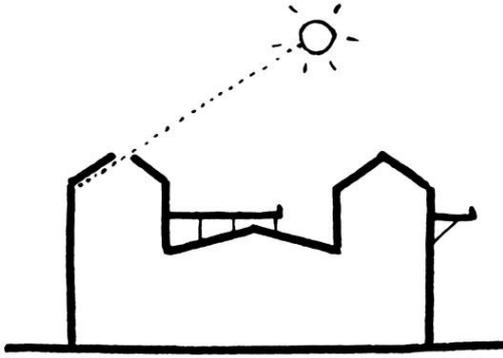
Sección esquemática de la adaptación de otras arquitecturas como observatorio.
